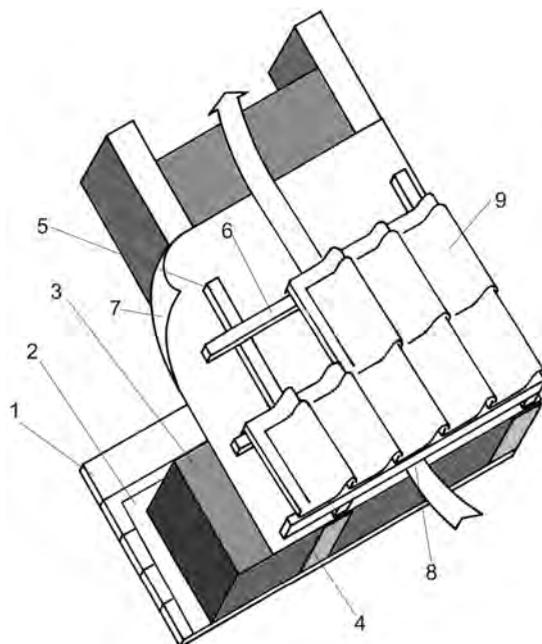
Теплоизоляция скатов крыши через установку теплоизоляции между стропилами:
